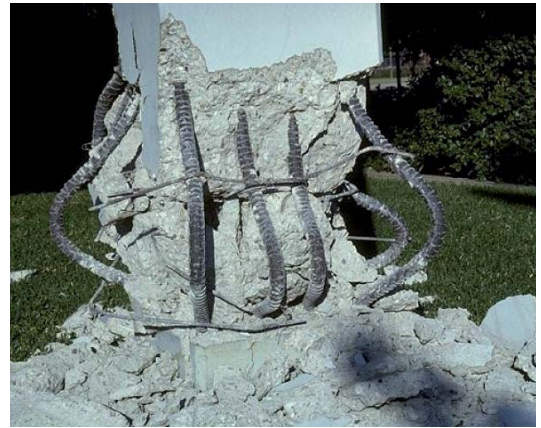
Fallo de pilar (armaduras transversales lisas y en cuantía insuficiente).
